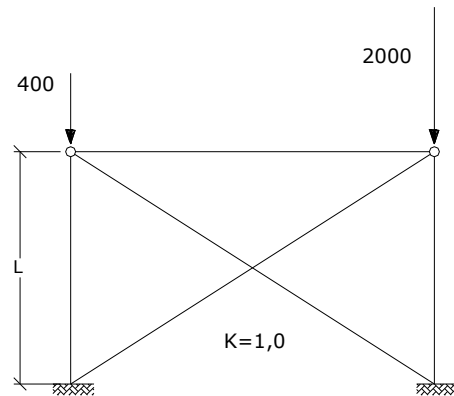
Pórtico indeslocável com carregamentos críticos
